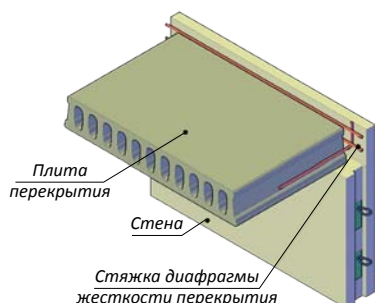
Анкеровка плит перекрытия при малой длине опоры.
